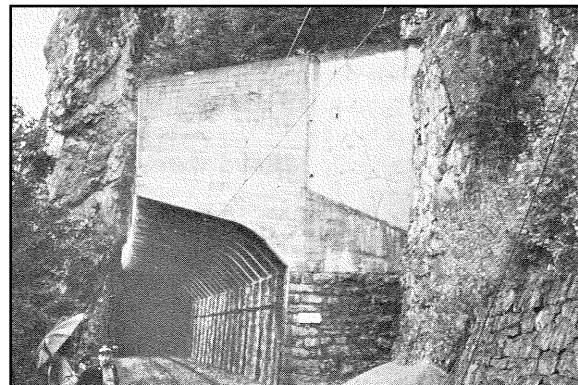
Galleria paramassi realizzata a protezione di un tratto stradale; si può notare il materiale detritico posto sulla volta e sul lato di monte (a sinistra) con lo scopo sia di attutire l'impatto dei blocchi che di mitigare il vistoso impatto ambientale della struttura, favorendo lo sviluppo di vegetazione a crescita spontanea -
